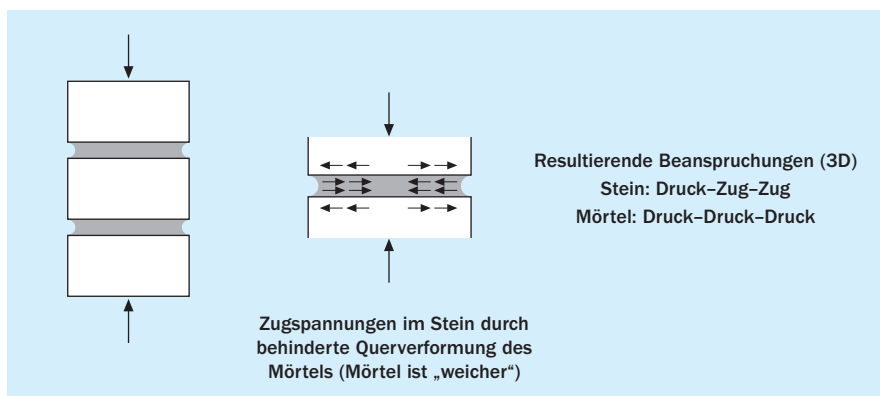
Zweidimensionale Darstellung des Versagensmechanismus von Mauerwerk unter Druckbeanspruchung
